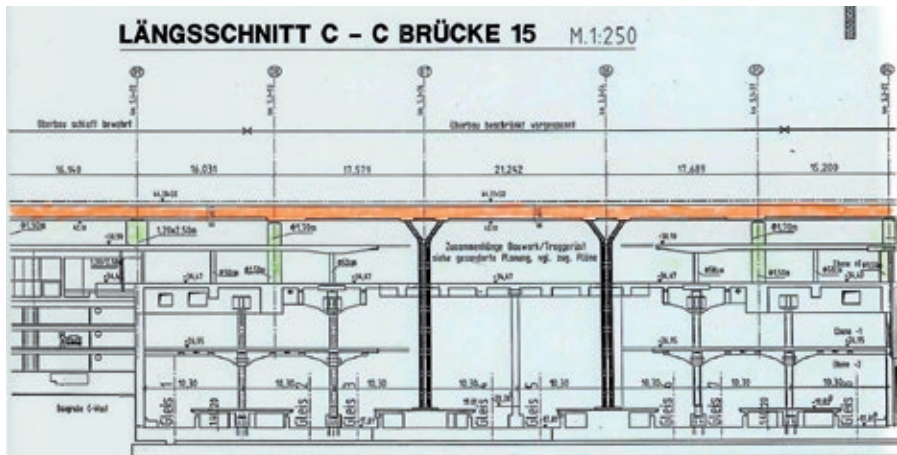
Längsschnitt der Spannbetonbrücken des Hauptbahnhofs Berlin (Ausschnitt)
